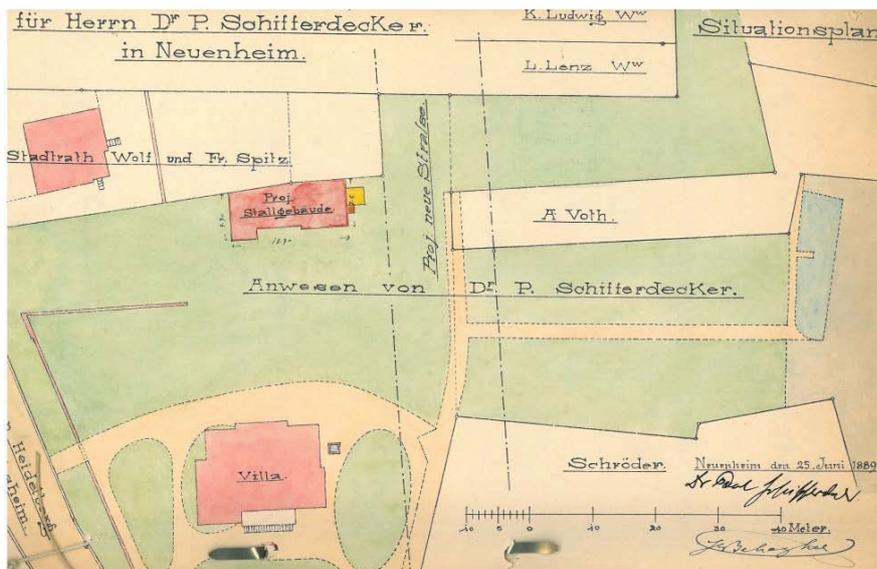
Lageplan von 1889 der Handschuhsheimer Landstraße für Umbaumaßnahme - Quelle Stadt Heidelberg
